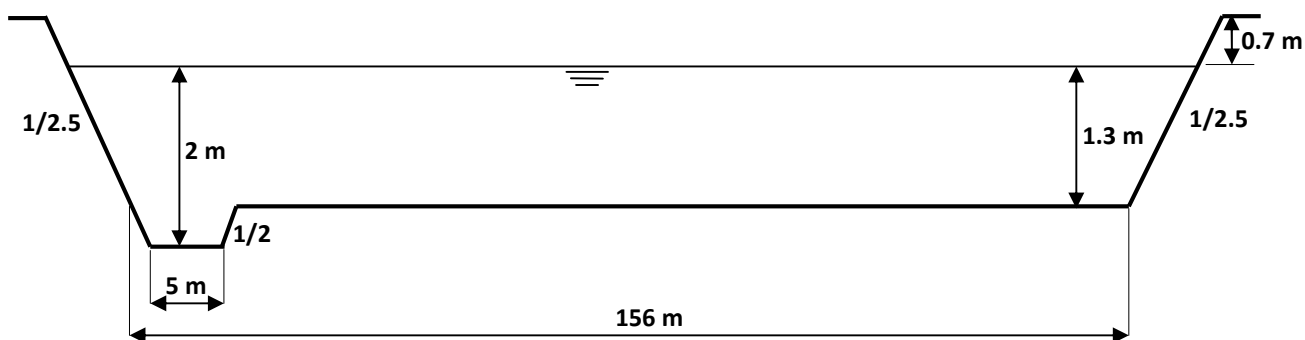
Coupe longitudinale du premier bassin (bassin de tête)
